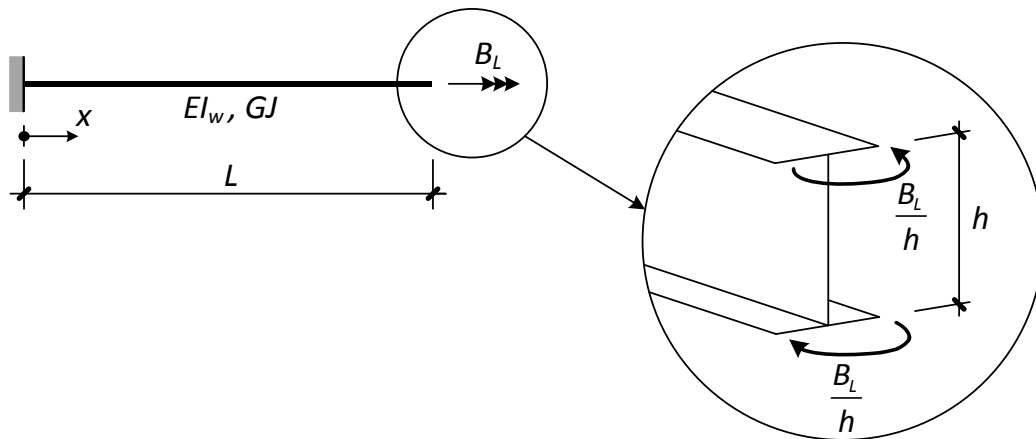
Barra em consola submetida a um bimomento  $B_L$  aplicado na extremidade livre.
